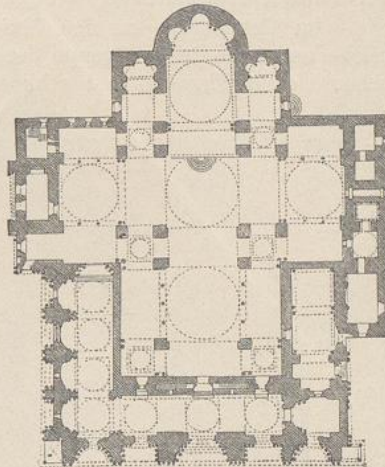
Grundriss von S. Marco zu Venedig
